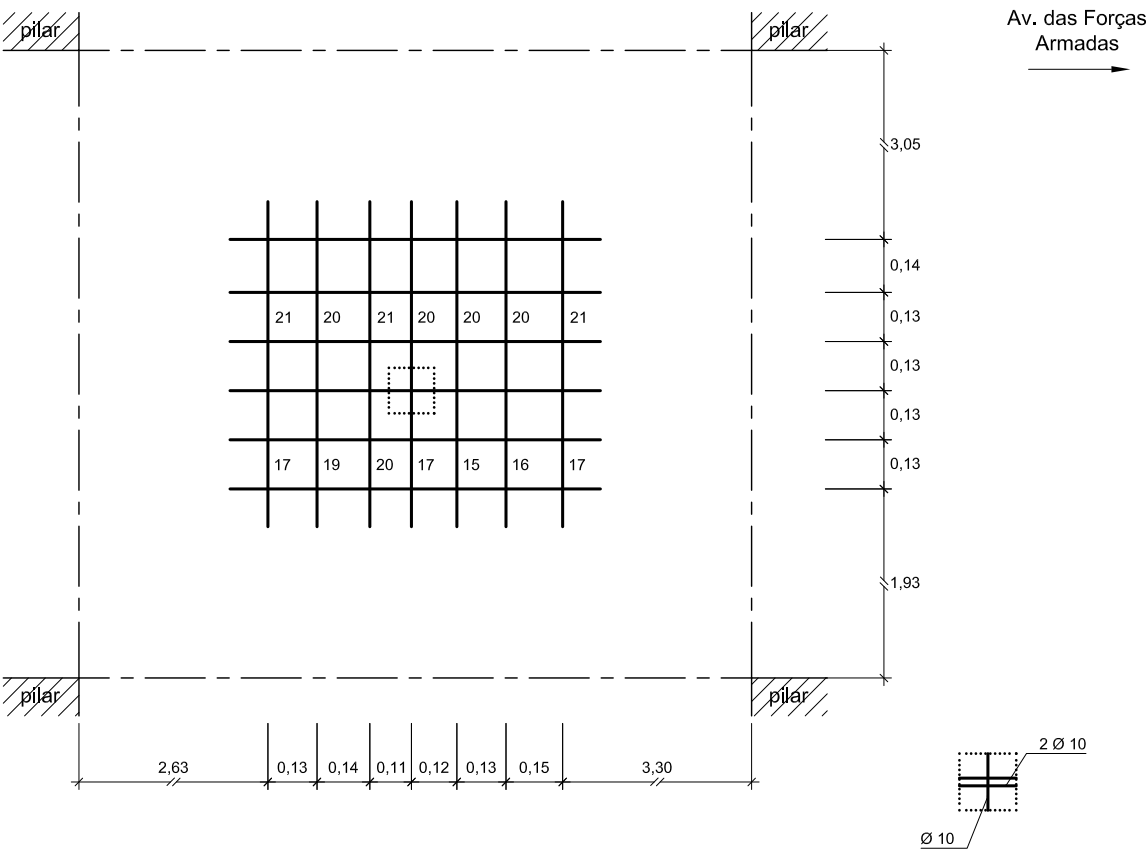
Idem. Idem. Idem. Idem. Pormenor da sondagem para confirmação do diâmetro das armaduras.
